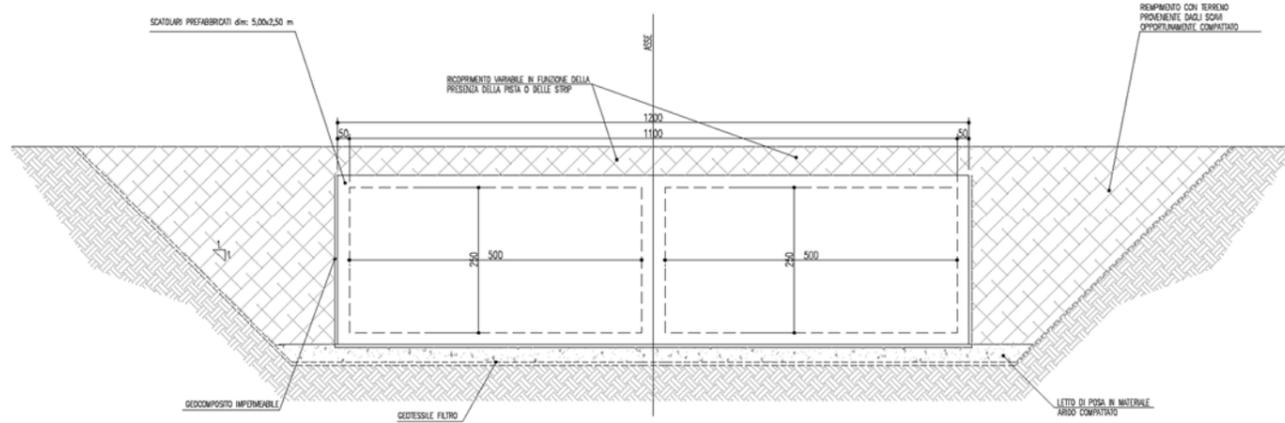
Sezione trasversale Canale Allacciante di Ponte Galeria – Tratto tombato
